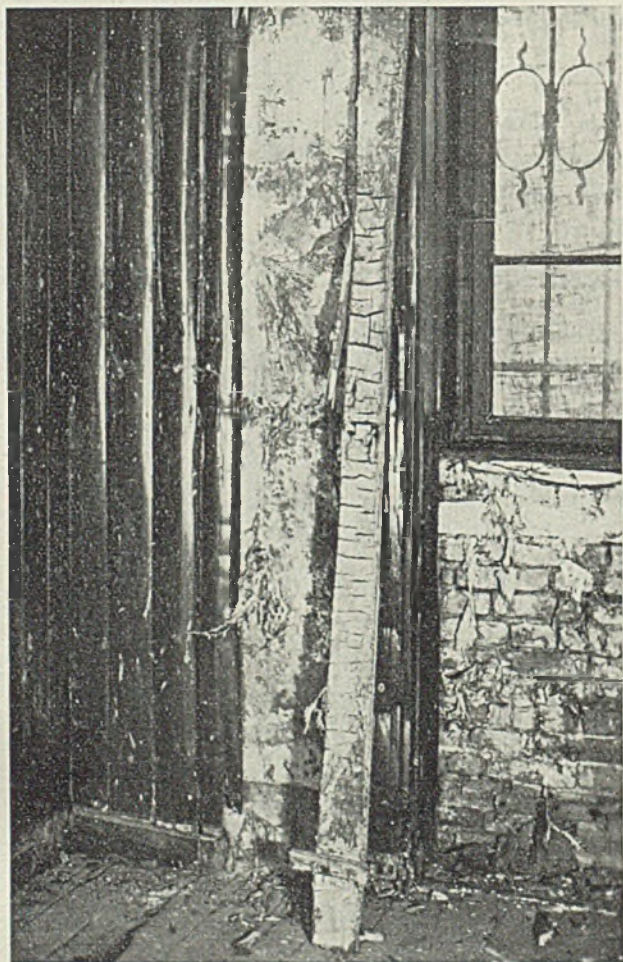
Zerstörung einer Wandvertäfelung durch den Hauschwamm. Selbst das Mauerwerk ist vollständig vom Pilz überzogen.
